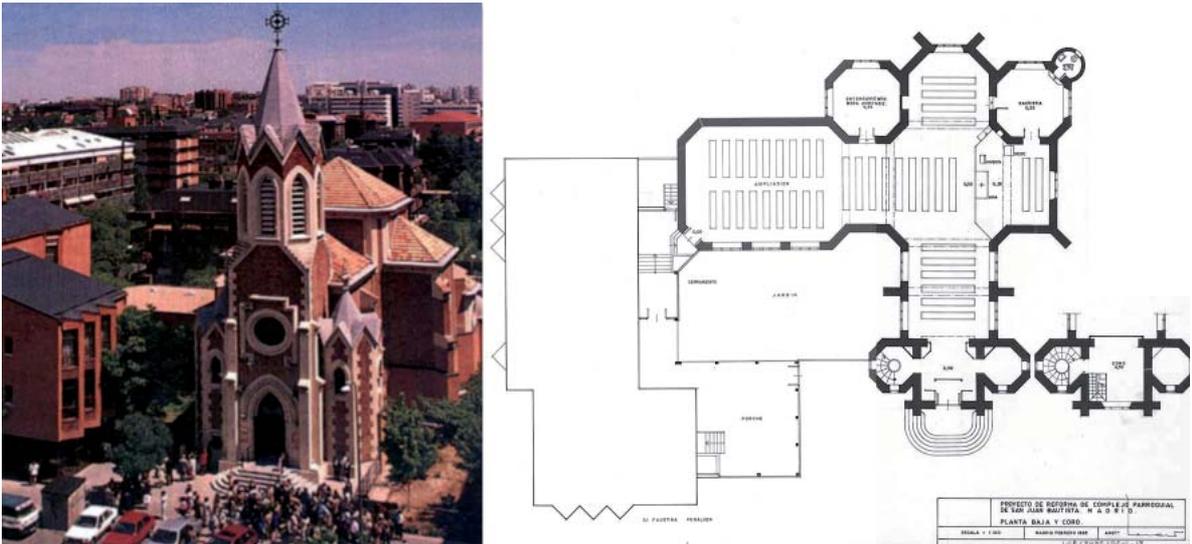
Luis Cubillo de Arteaga. Complejo parroquial de San Juan Bautista, Madrid, 1985; vista exterior y planta reformada.
